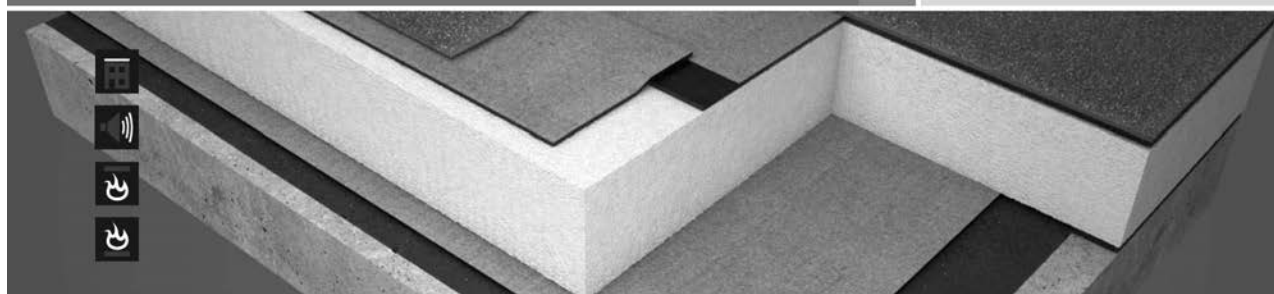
Detail ukončení hydroizolace u okapu (skladba DEKROOF 03)
